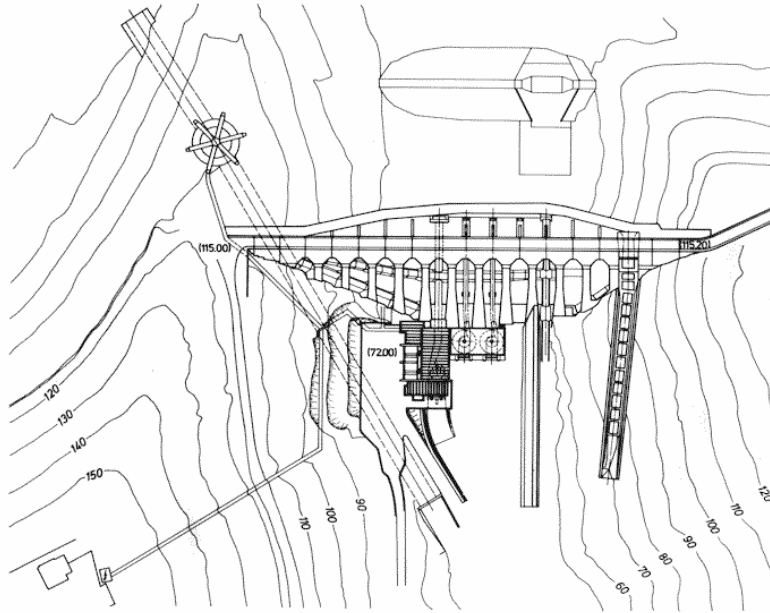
Planta de uma barragem de contrafortes (barragem da Pracana, CNPGB).
